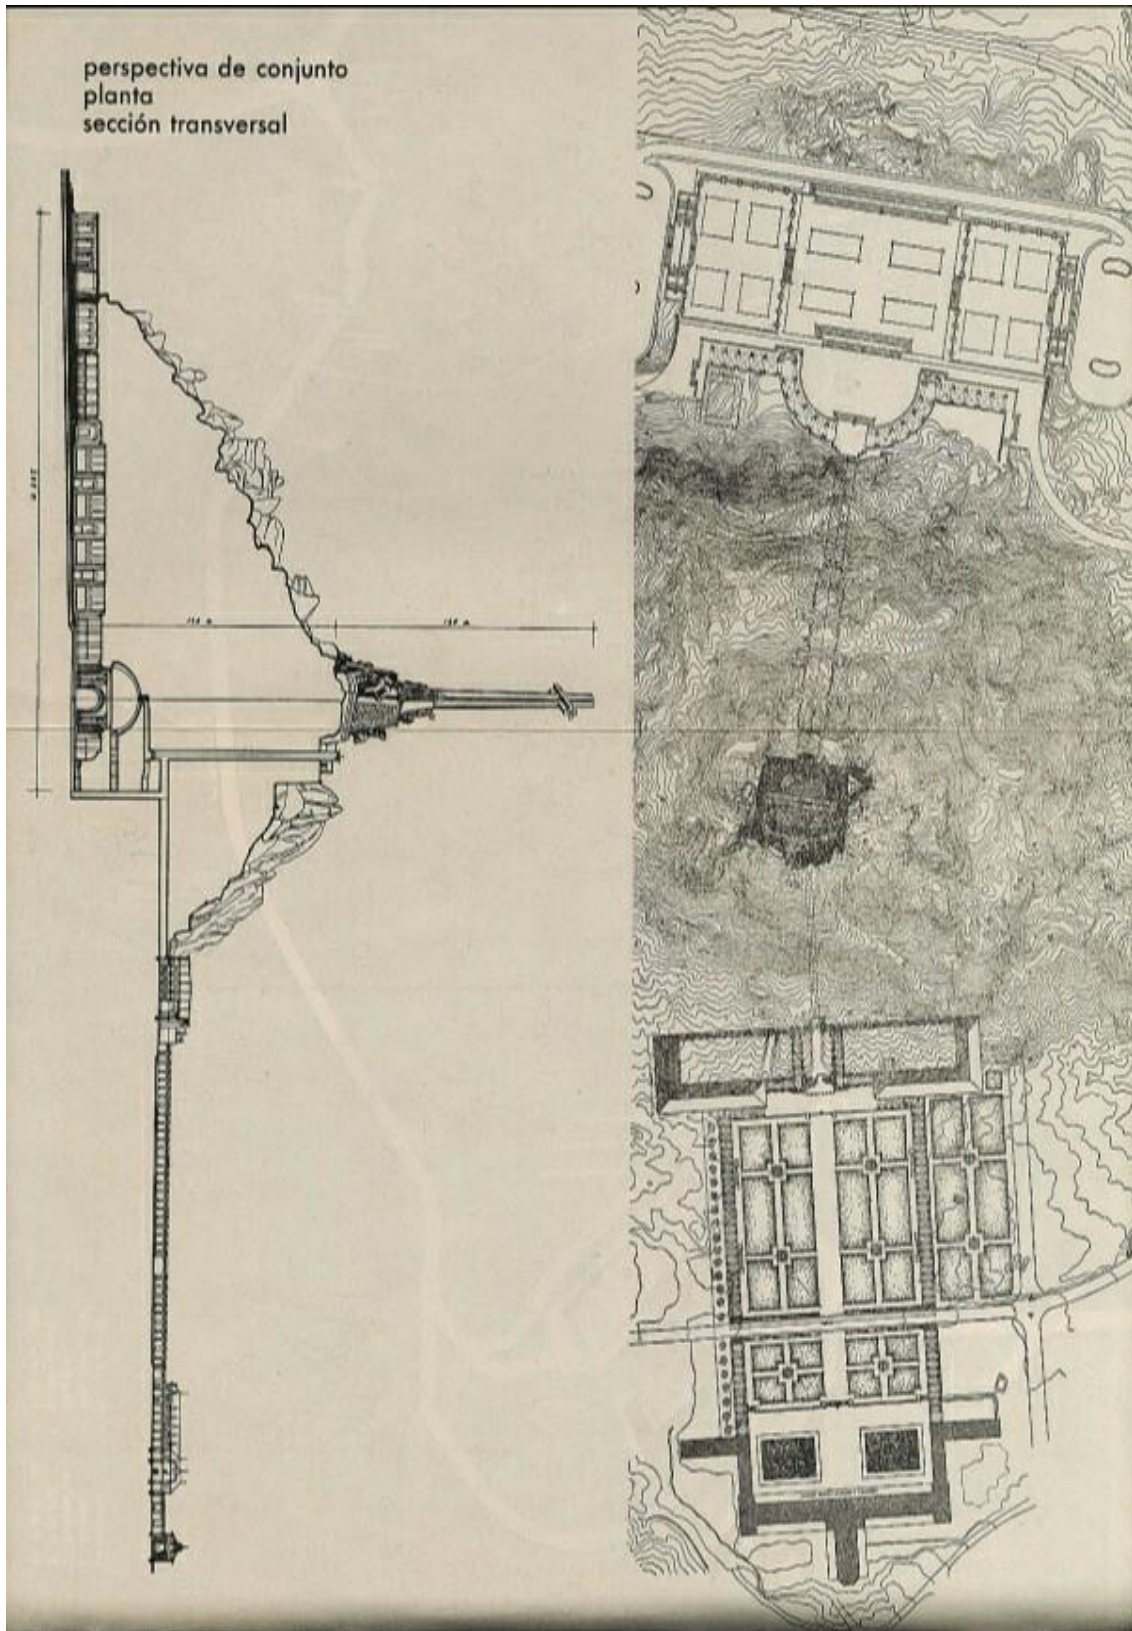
Planta y sección.* Planos del arquitecto. Diego Méndez. 1982.
